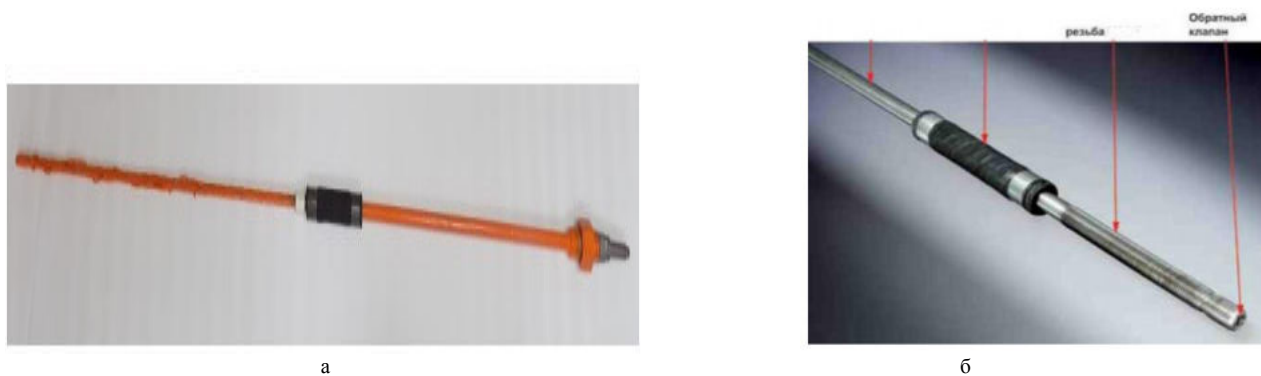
Способ крепления подготовительной горной выработки в зоне нарушения
